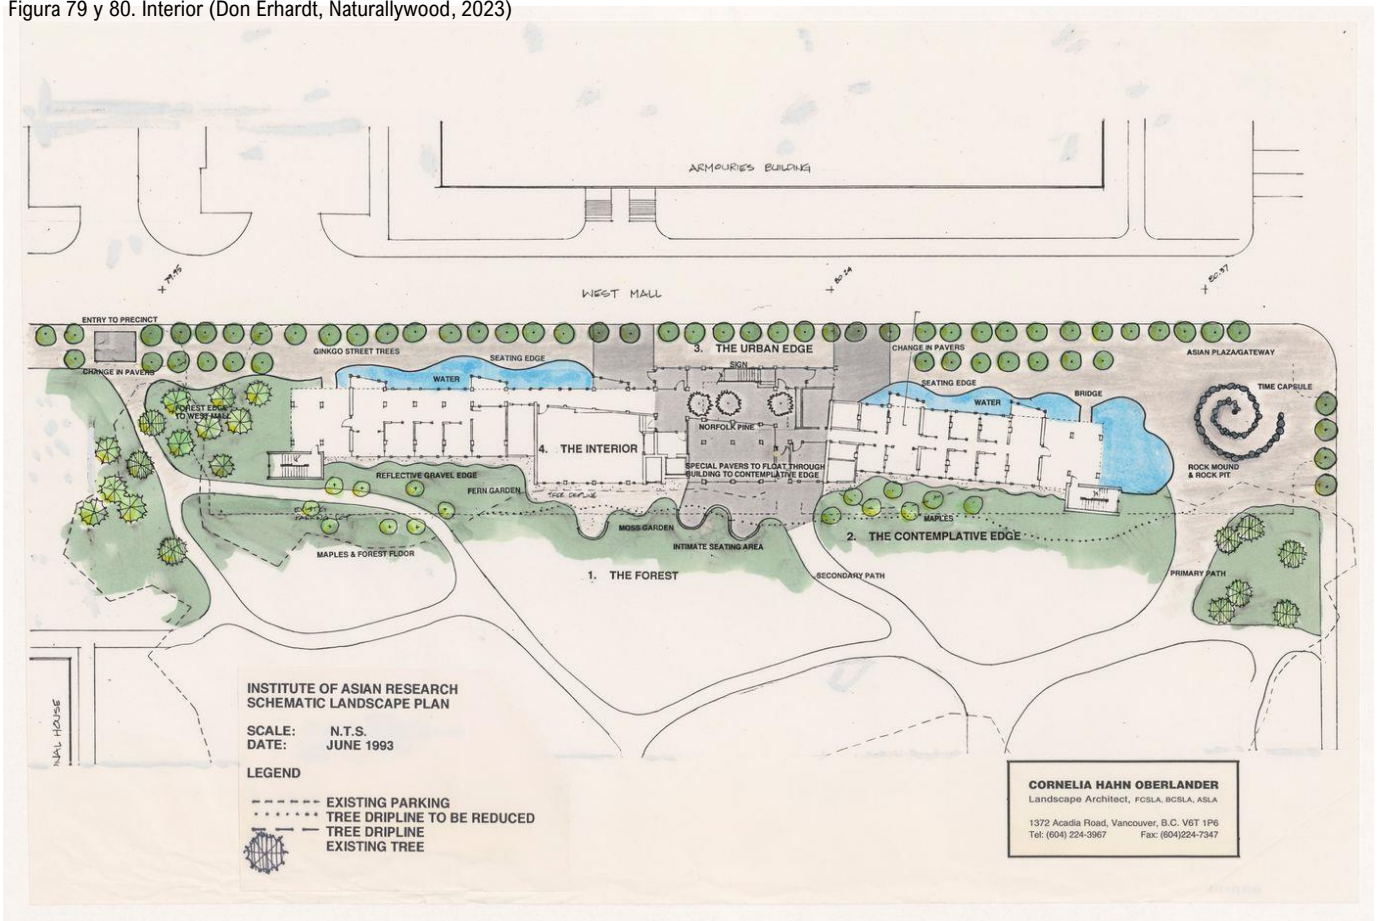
Dibujo de planta arquitectónica (Fondo Cornelia Hahn Oberlander, CCA, 1993)
